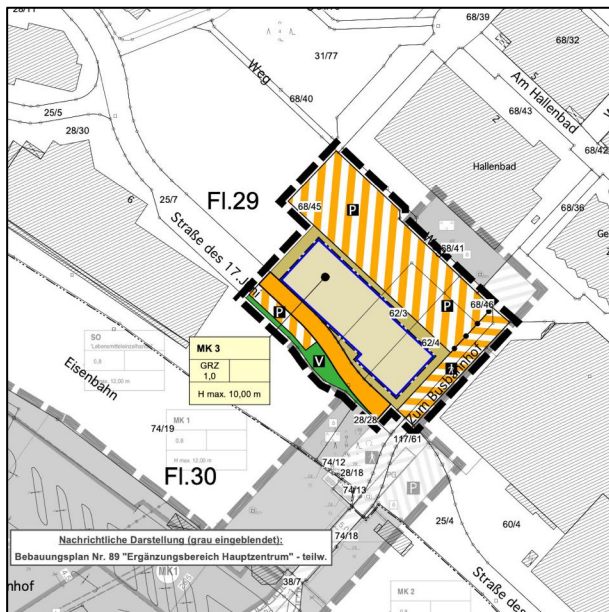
Bebauungsplan Nr. 89 "Ergänzungsbereich Hauptzentrum" – 1. Änderung
